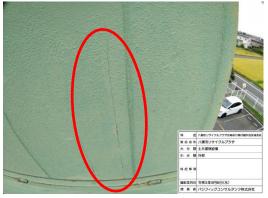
工場棟壁面のひび割れ(南面及び東面)
